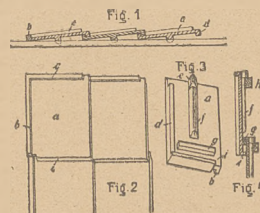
przedstawia przekrój poprzeczny warstwy dachówek leżących na dachu. Położenia każdej dachówki, jak się z tego okazuje, jest pochylone, co jak niżej zobaczymy, ma pewne znaczenie. Na figurze tej *b* oznacza listewkę podłużną wierzchnią, *d* takąż listewkę spodnią a *c* listewkę poprzeczną wierzchnią. Na figurze 2 jest widok z góry pokrycia dachowego, gdzie *b* i *c* przedstawiają odnośne szczegóły jak fig. 1 a *i* oznacza listewkę poprzeczną spodnią. Figura trzecia daje nam obraz dachówki Joedeckowskiej od spodu. Nos zaznacza nam litera *l*, żeberko podłużne *f* oraz listewkę poprzeczną drugą *g*; wreszcie na figurze 4 widzimy przekrój podłużny części dachu; dachówki opierają się tu na łatach *h*.
